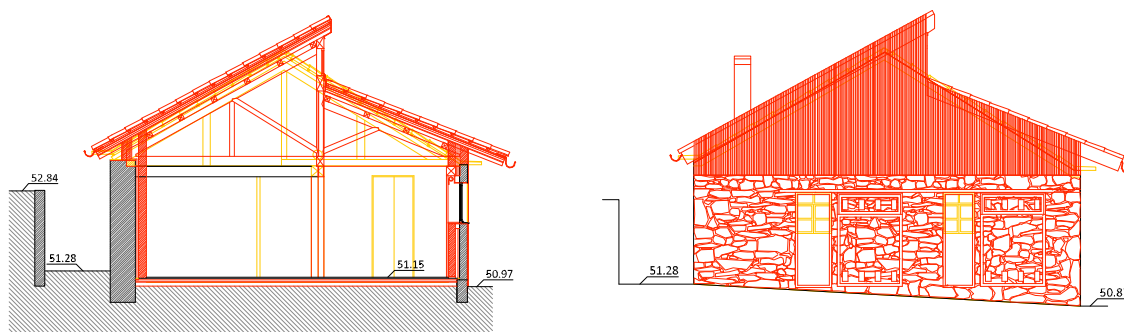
Corte transversal AA' e Alçado Sudoeste – elementos a manter, a retirar e a construir
